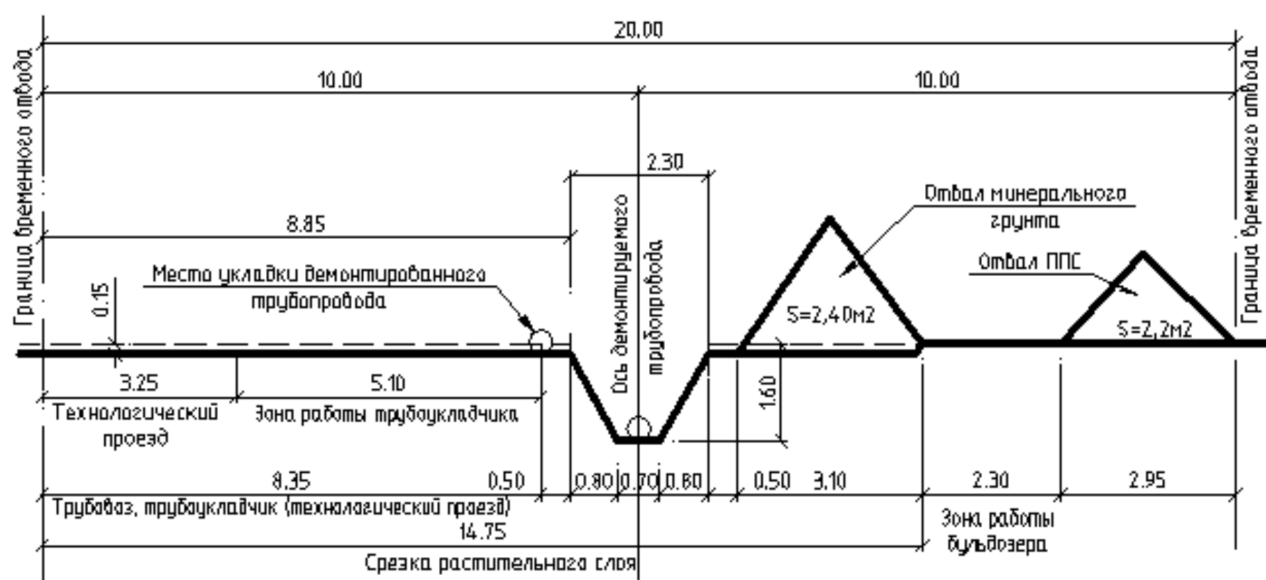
Схема строительной полосы при демонтаже существующего керосинопровода
